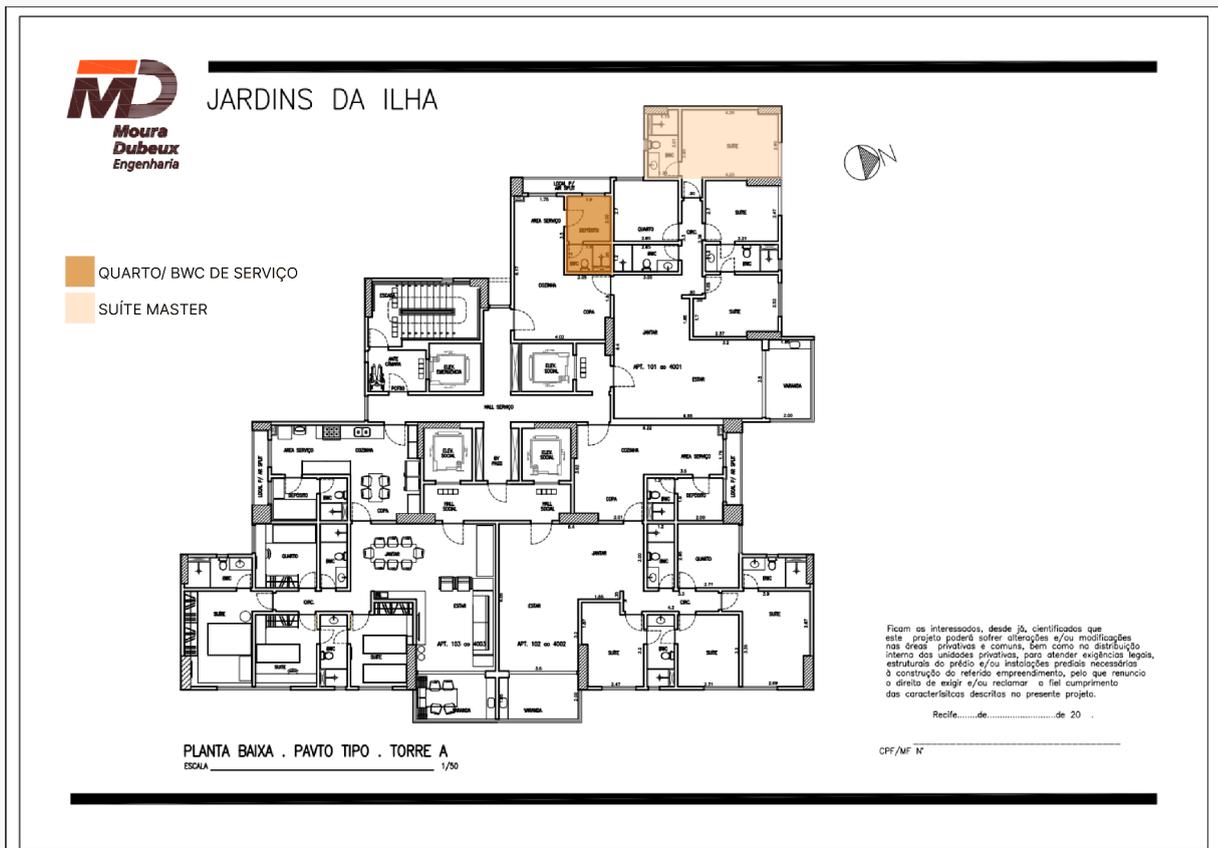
Planta Baixa Edifício Jardins da Ilha.
